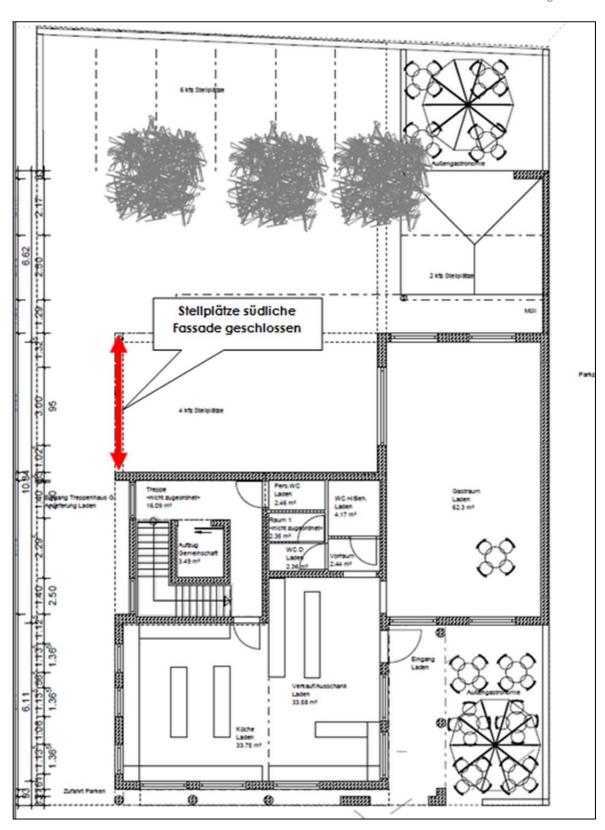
Darstellung Grundriss des Vorhabens, Erdgeschoss
